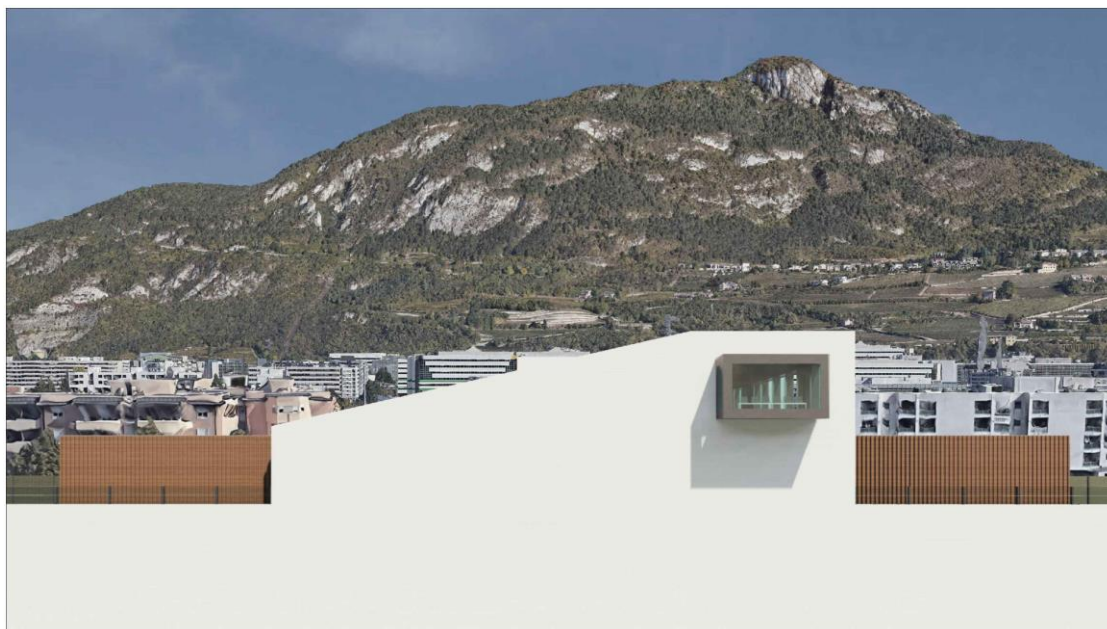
Prospetto fabbricato viaggiatori fronte trincea
